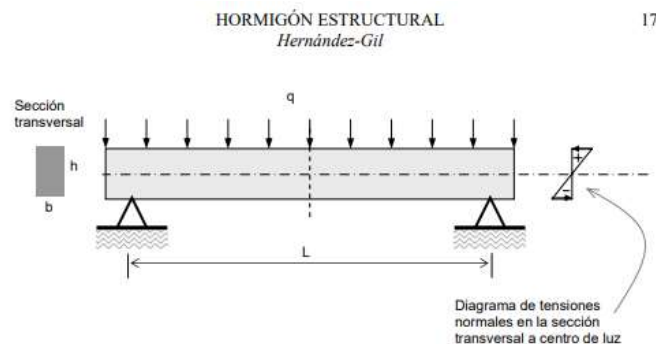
Viga fabricada exclusivamente con hormigón.
